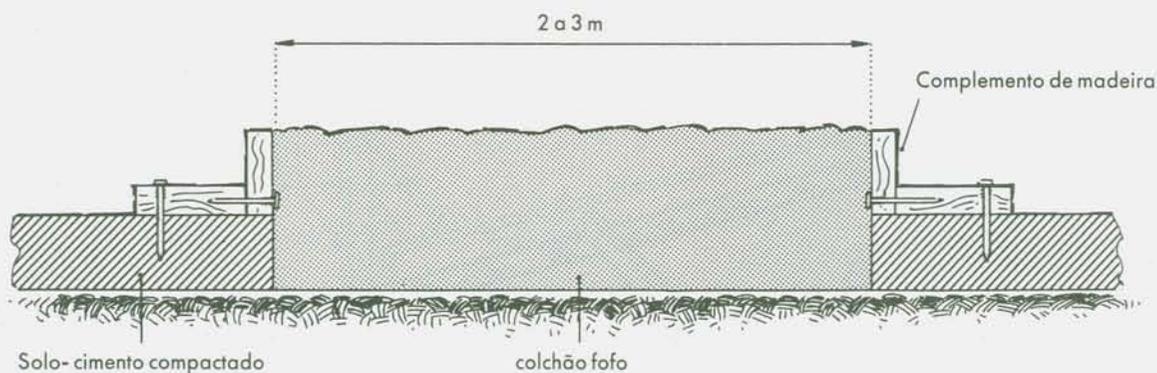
Detalhe de fixação do complemento das fôrmas sobre as faixas concluídas
